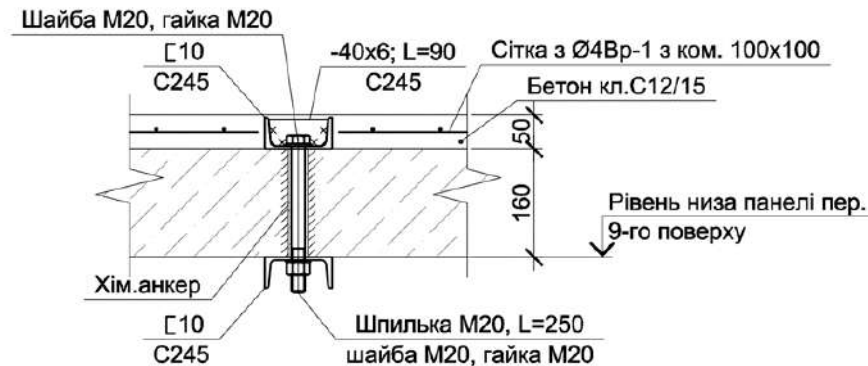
Пропоноване конструктивне рішення плити нарощування панелі перекриття
